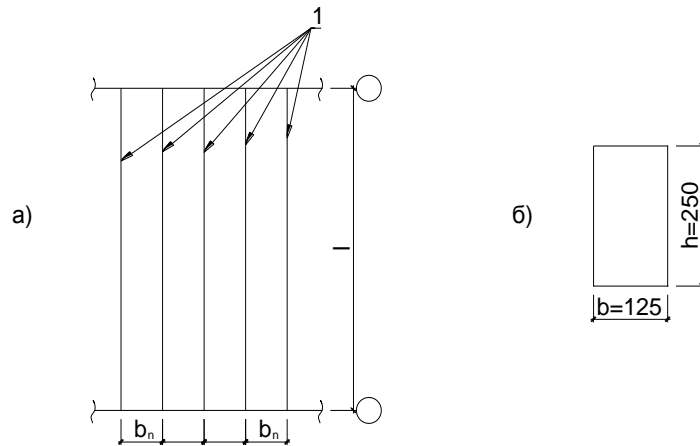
Исходные данные: а – схема расположения балок; 1 – деревянная балка перекрытия; l – пролет балок; b_n – шаг балок; б – поперечное сечение деревянной балки
